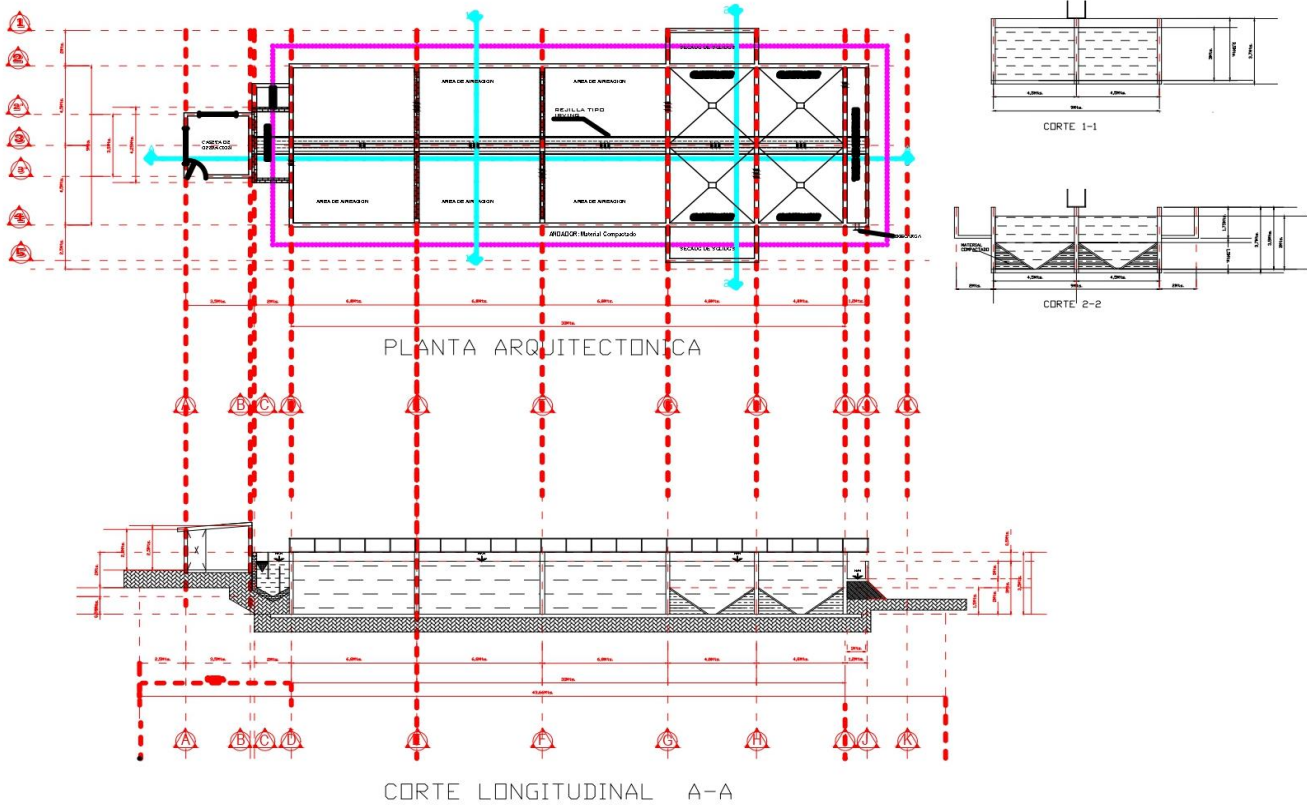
Planta Arquitectónica del Diseño de una PTAR
